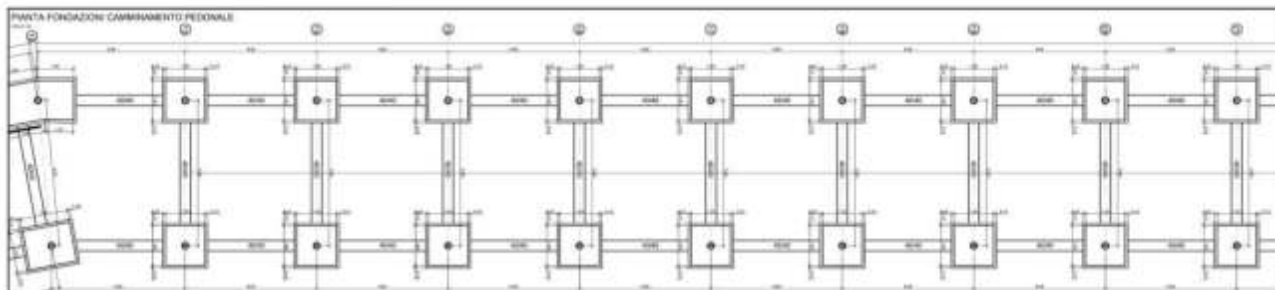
Estratto pianta delle fondazioni del Camminamento pedonale
